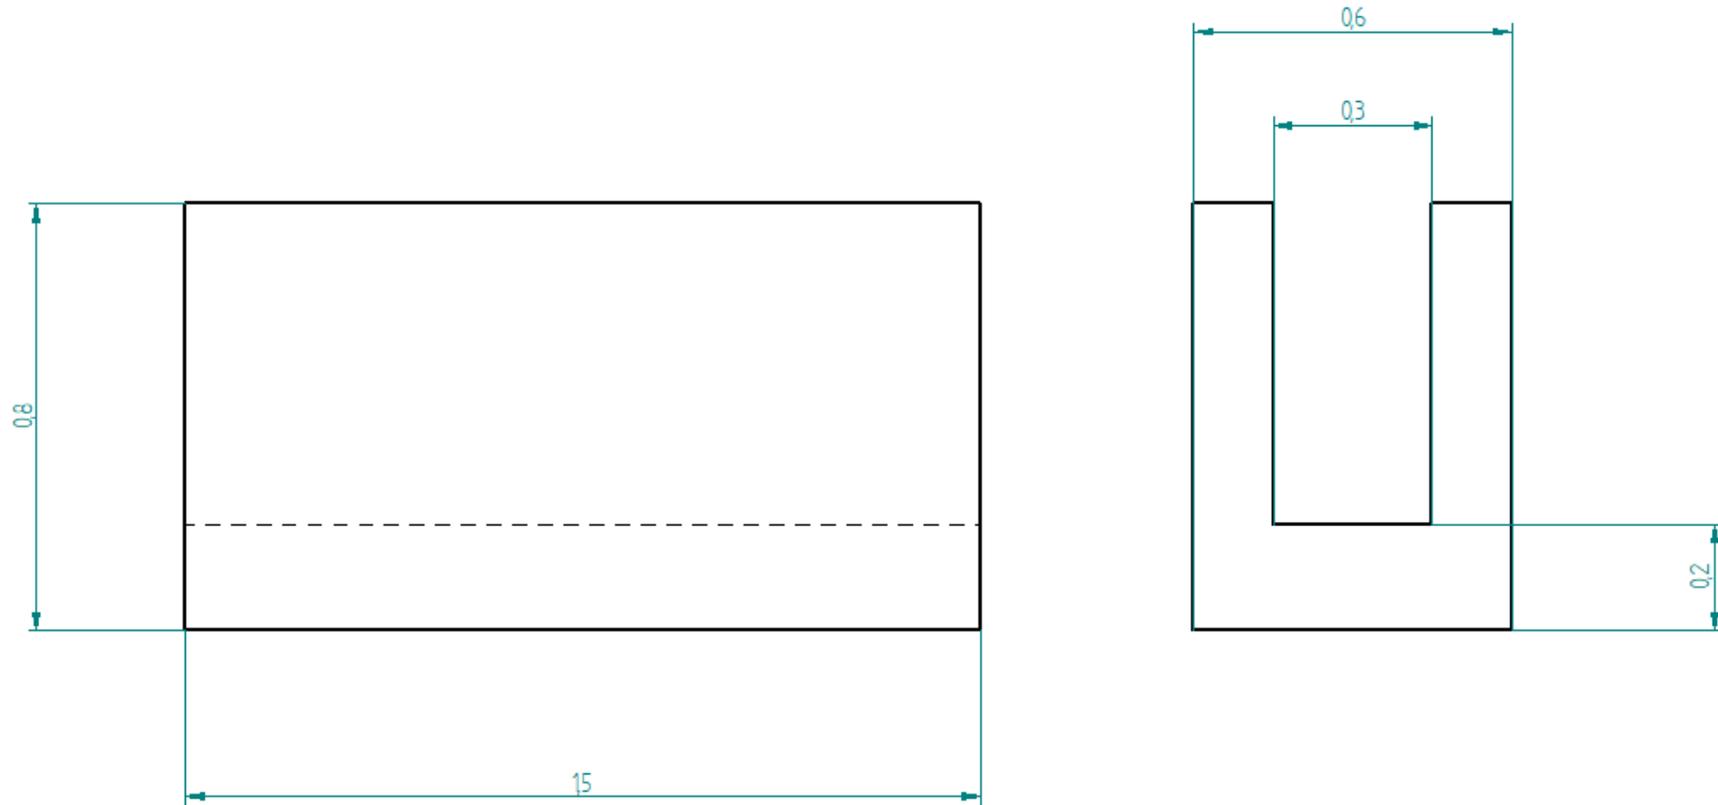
Plano constructivo del equipo desarenador (cotas en metros).
